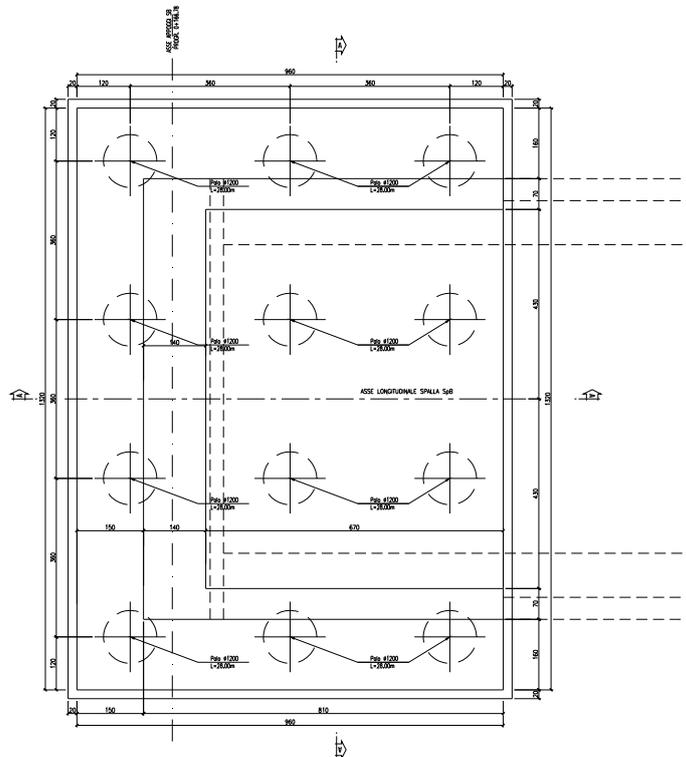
Pianta fondazioni spalla B.
